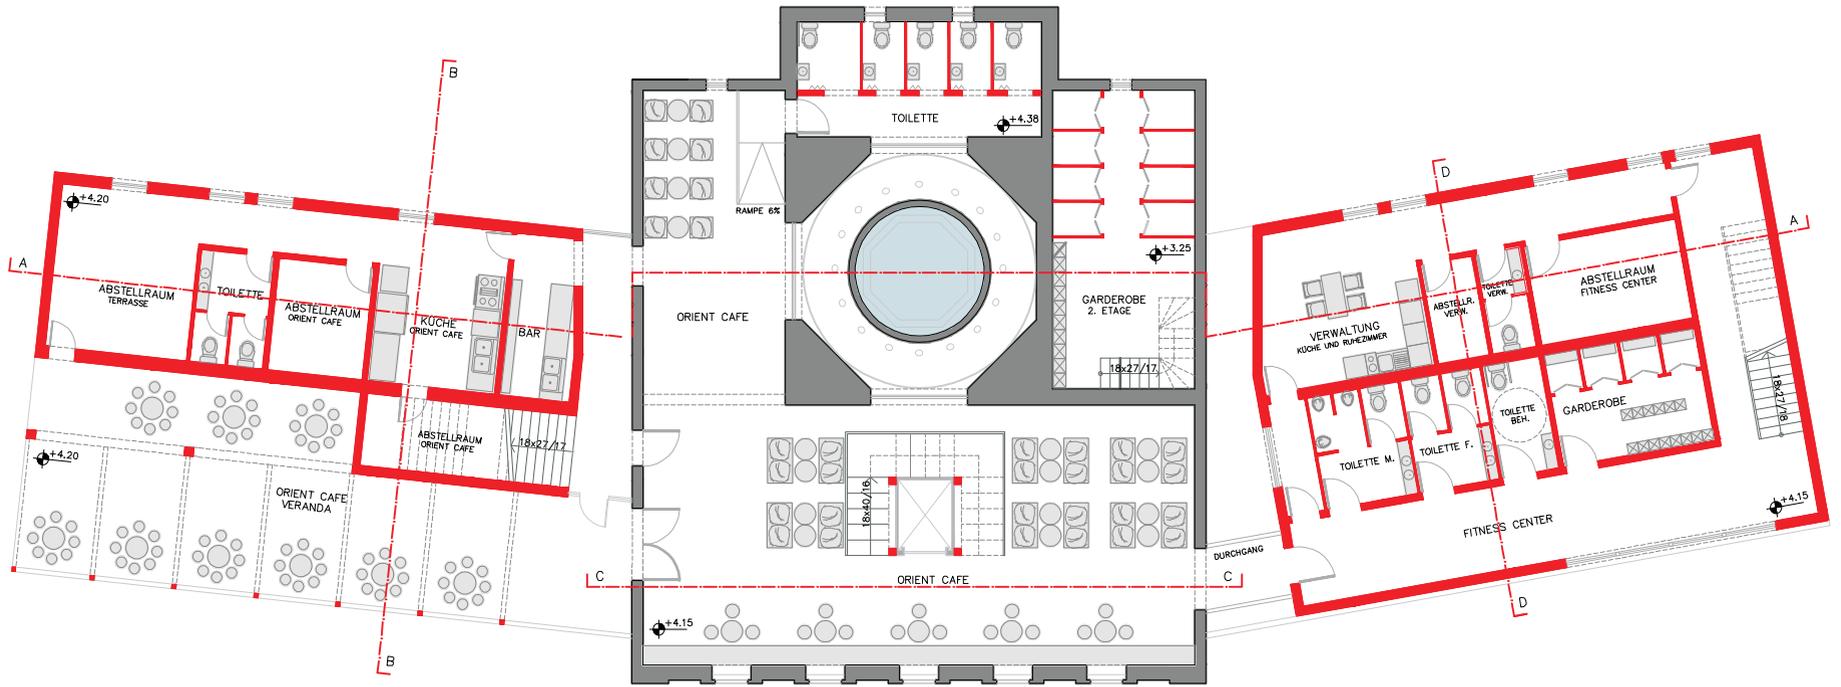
Grundriss 1. Obergeschoss M 1:200
